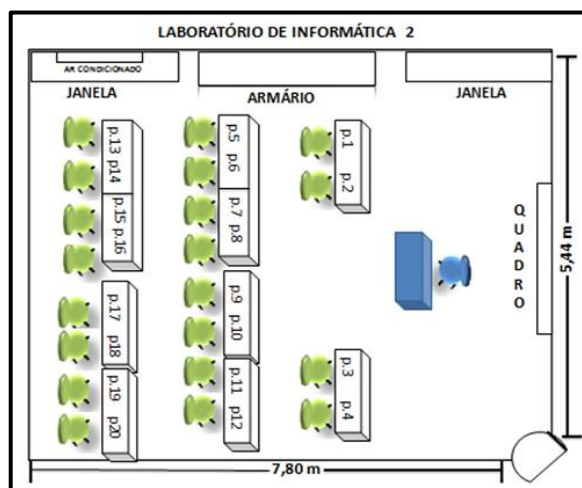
PLANTA BAIXA DO LABORATÓRIO DE IPI 2
